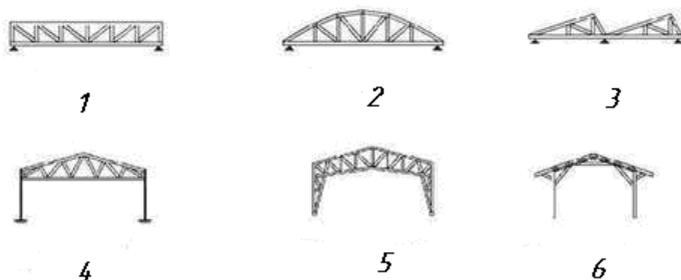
Виды ферм: 1 – ферма-балка с параллельными поясами; 2 – арочная ферма; 3 – шедовая ферма; 4 – порталная ферма с защемлением; 5 – двухшарнирная порталная ферма; 6 – порталная ферма
